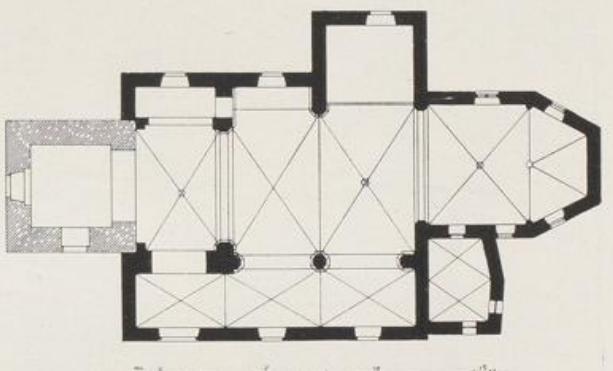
Gladbach. Grundriss der kathol. Pfarrkirche.
